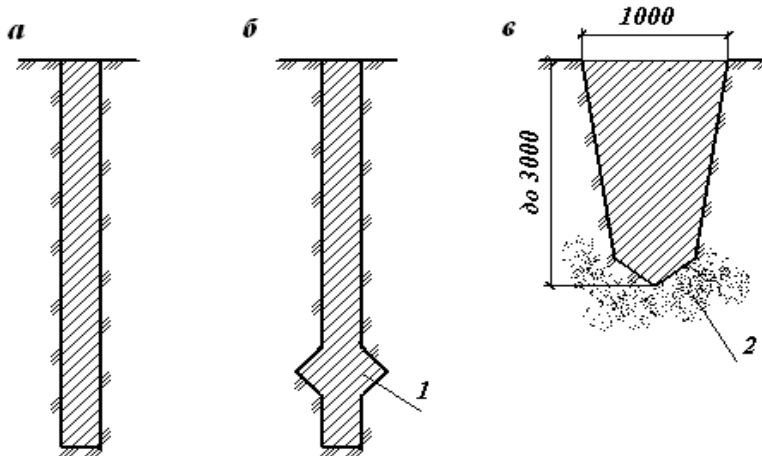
Набивні палі і фундаменти у витрамбованих котлованах: а – буронабивна паля з однаковим перерізом ствола; б – те ж з поширеною п'ятою; в – витрамбований котлован; 1 – поширена п'ята; 2 – ущільнена зона ґрунту
